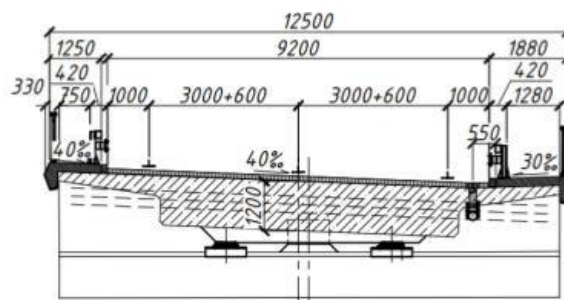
Схема поперечного перерізу прогонової будови мосту з монолітною залізобетонною плитою
